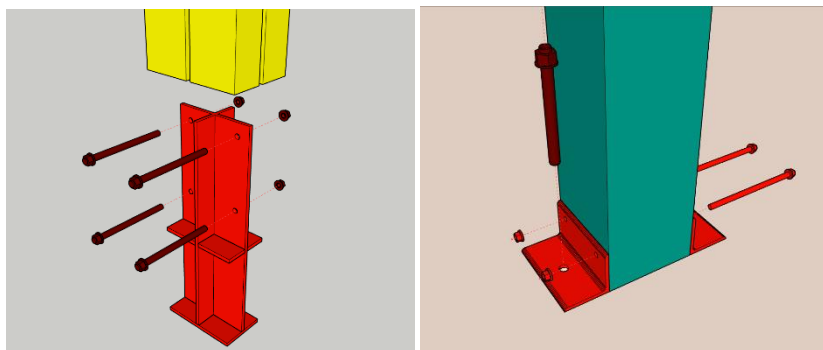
Опорные узлы деревянных колонн и стоек
